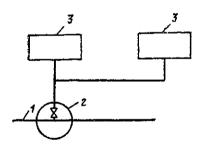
Схема водопроводного ввода на два здания 1 — водопроводная магистраль 2 — водопроводный котолец, 5 — здание
